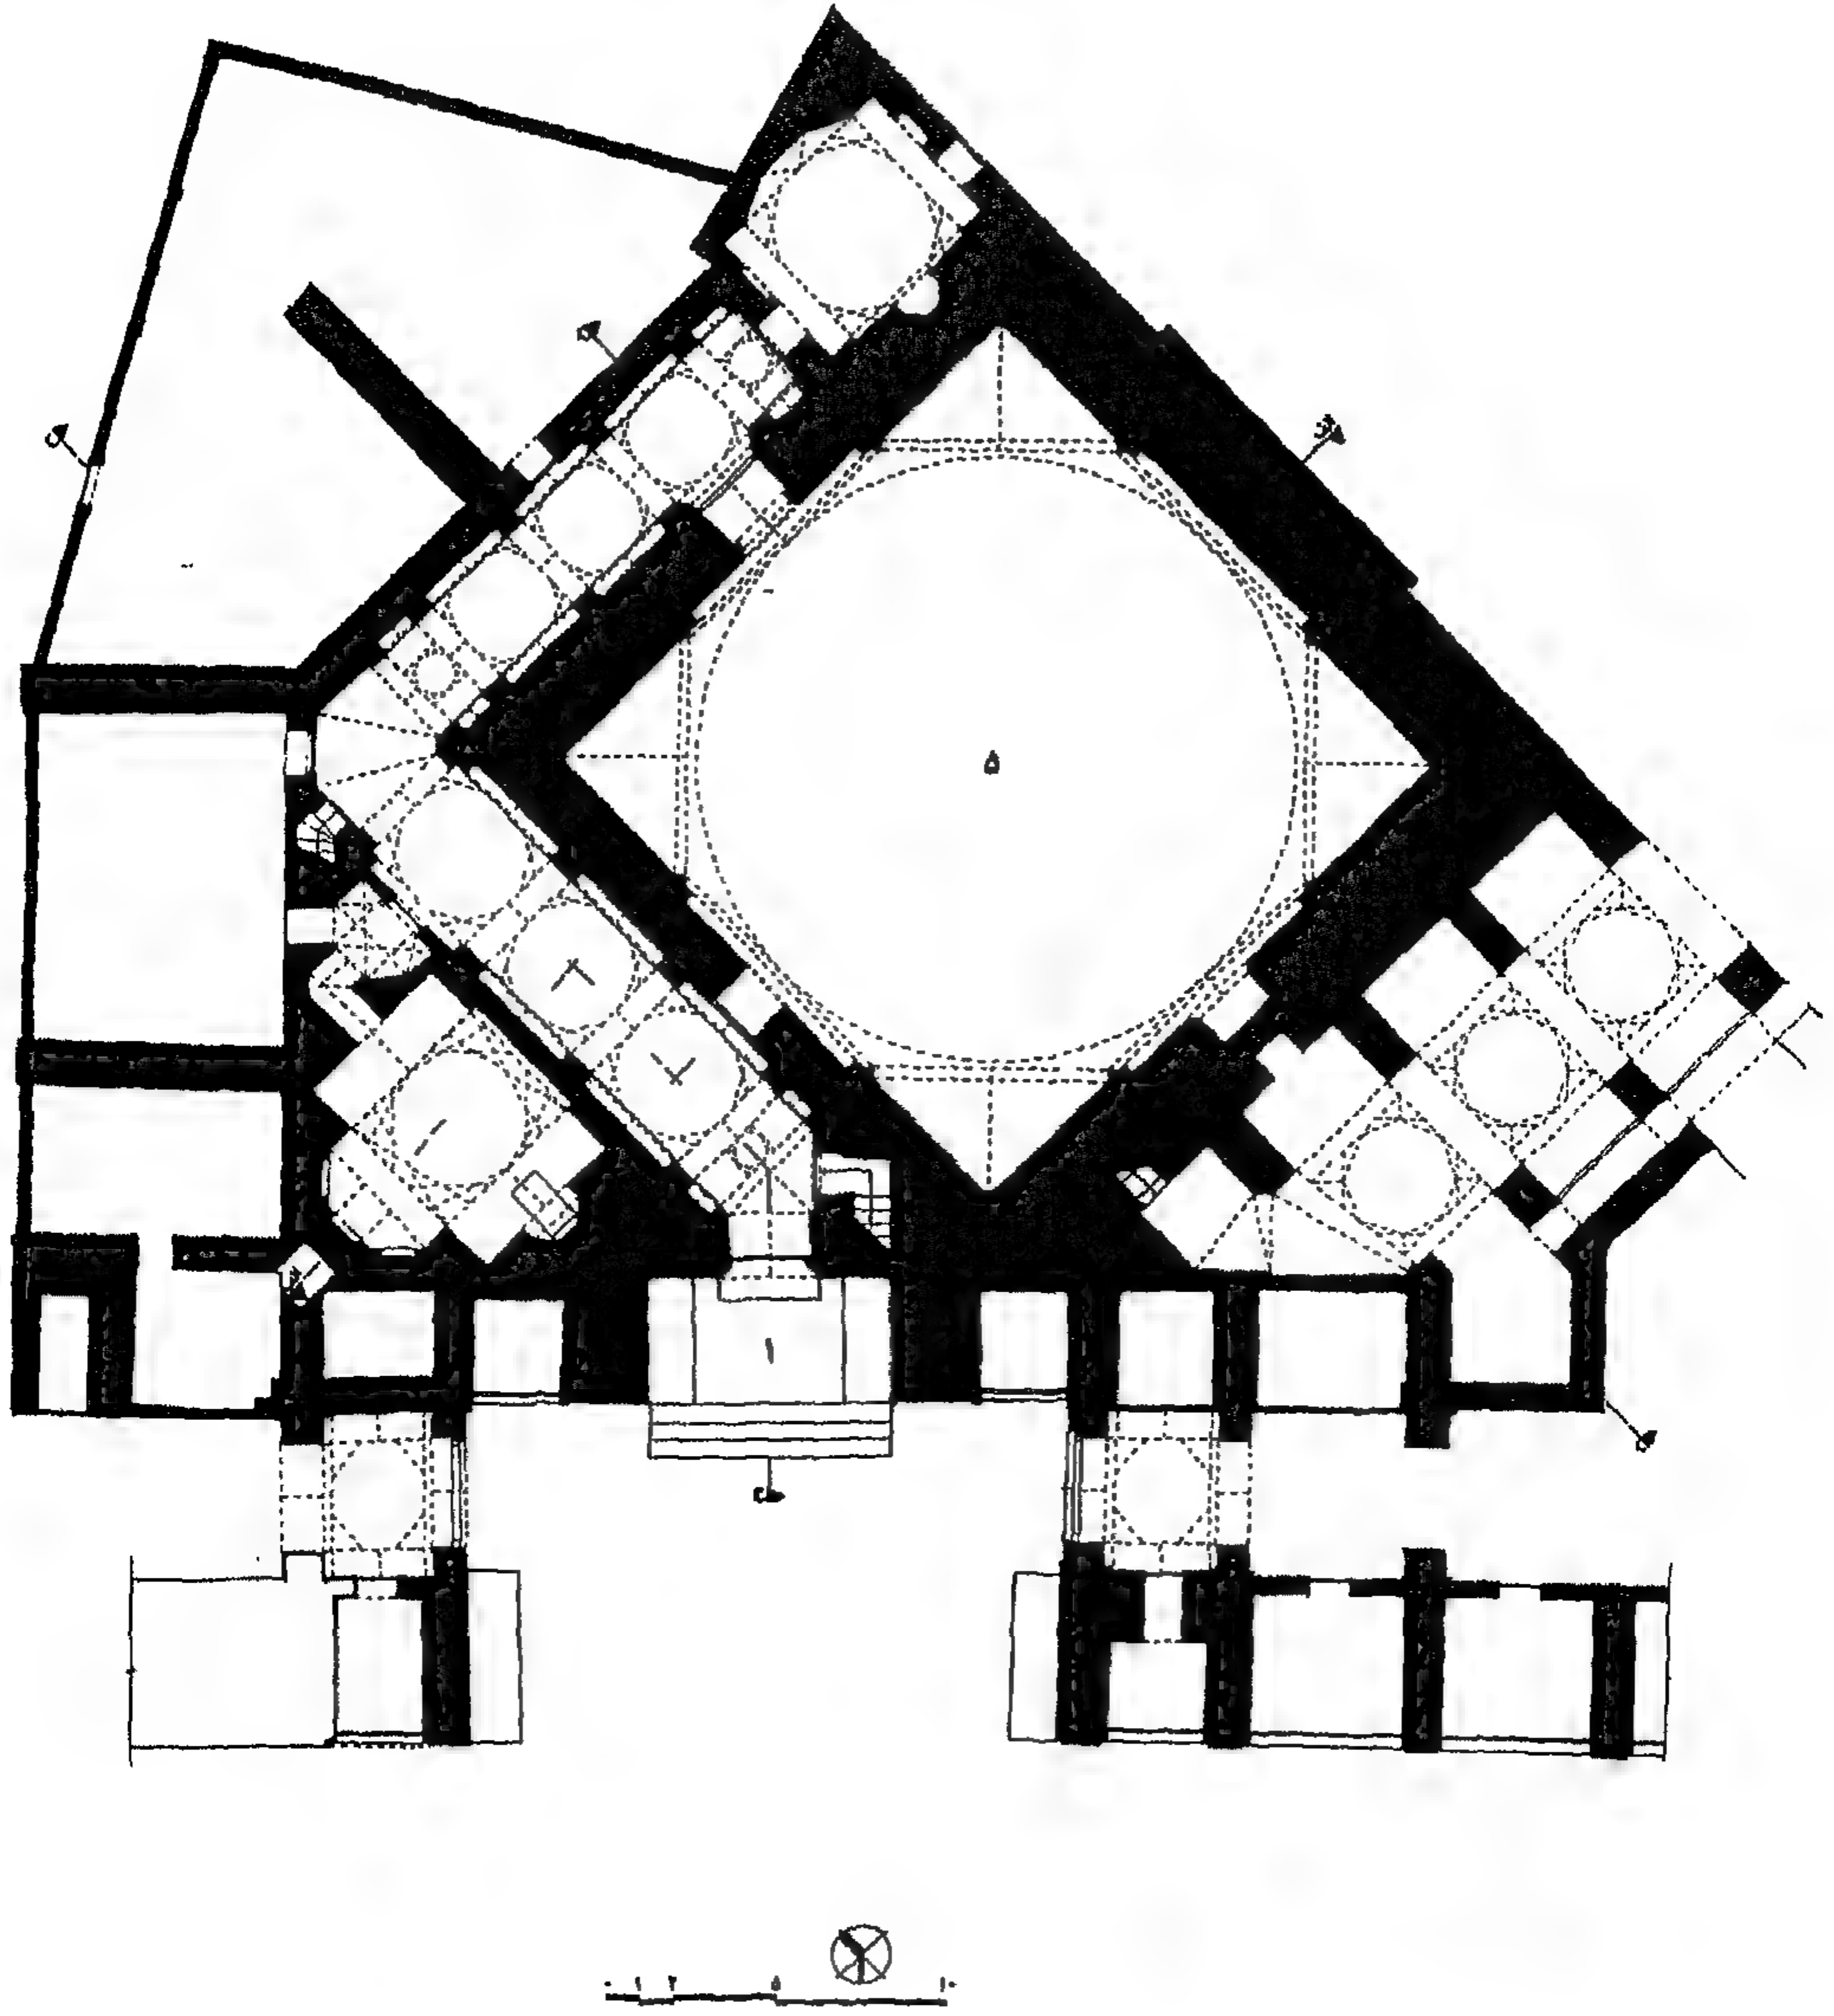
مسقط أفقي للمسجد الجديد (يني جامع)
